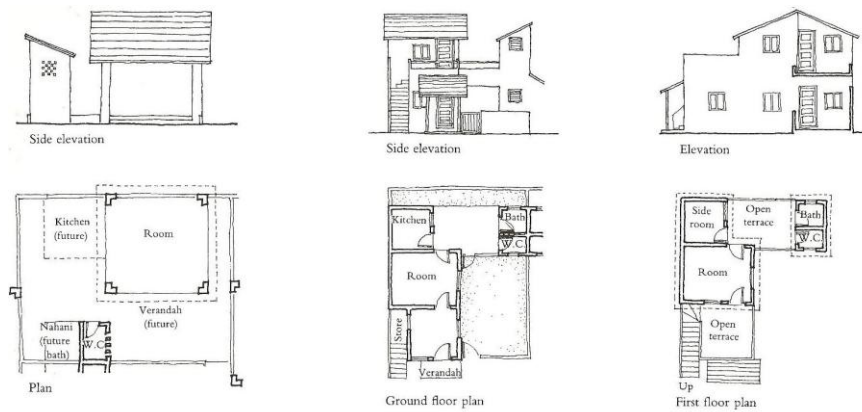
Planos de planta baja, 1ª planta y alzados de las tipologías A y E
